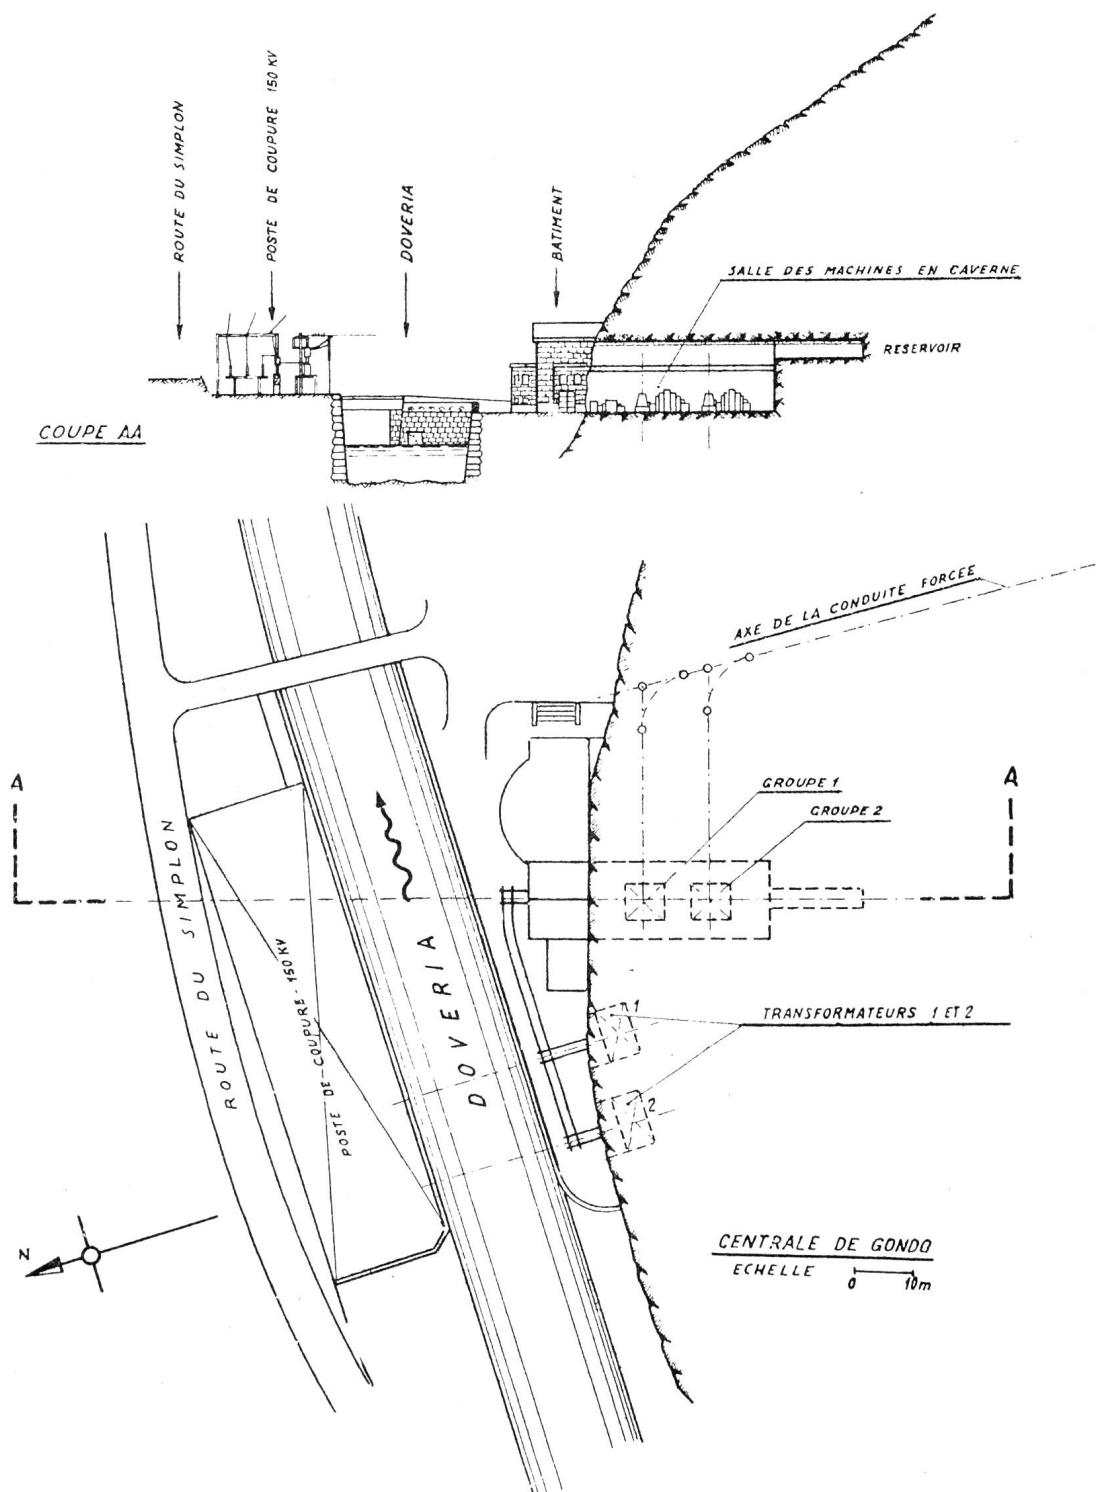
Plan de situation et coupe de la centrale de Gondo
